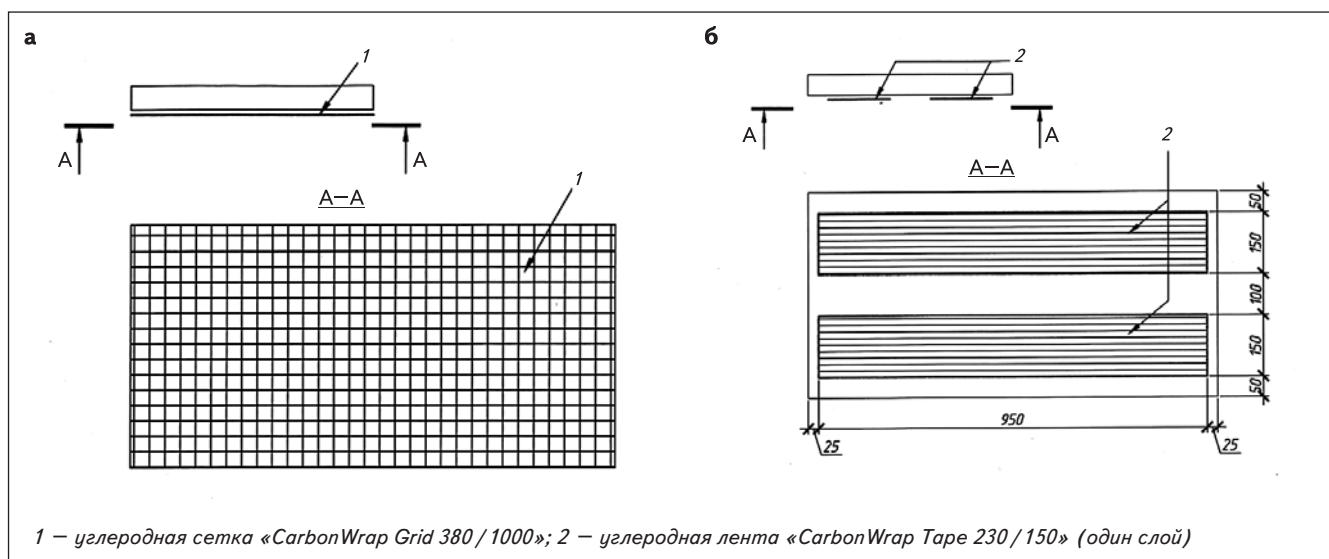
Схемы внешнего армирования модельных плит перекрытия
